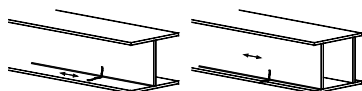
Rißtypen 2 und 3, Konstruktionsdetails und Beanspruchung
